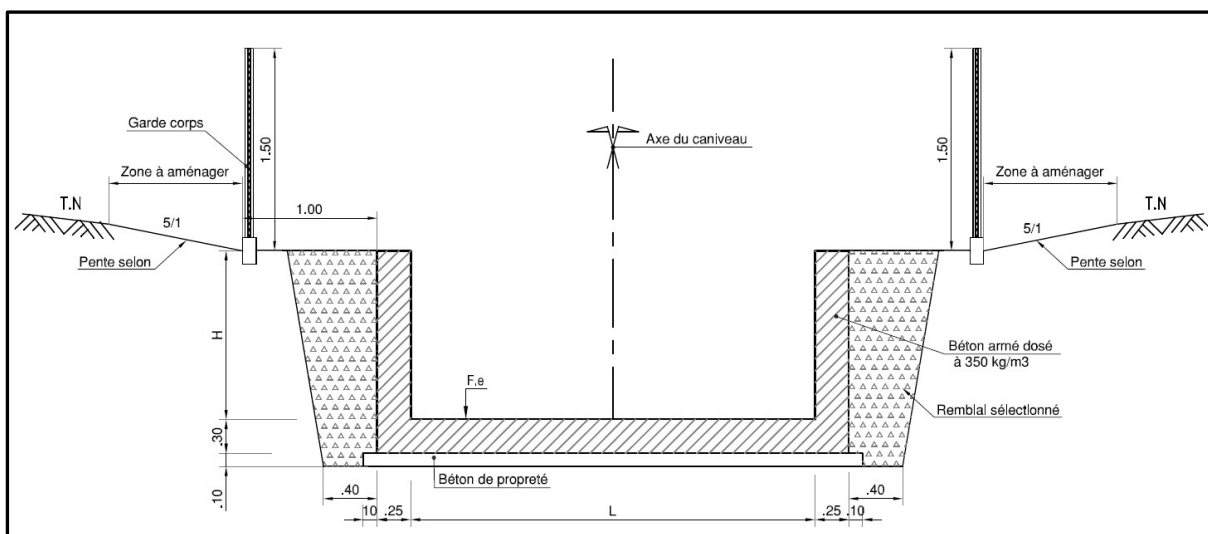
Section type canal rectangulaire en béton, Source : APD.
